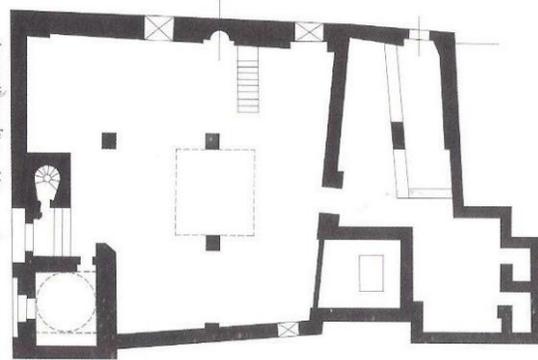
المسقط الأفقي لمسجد الشيخ مطهر.
